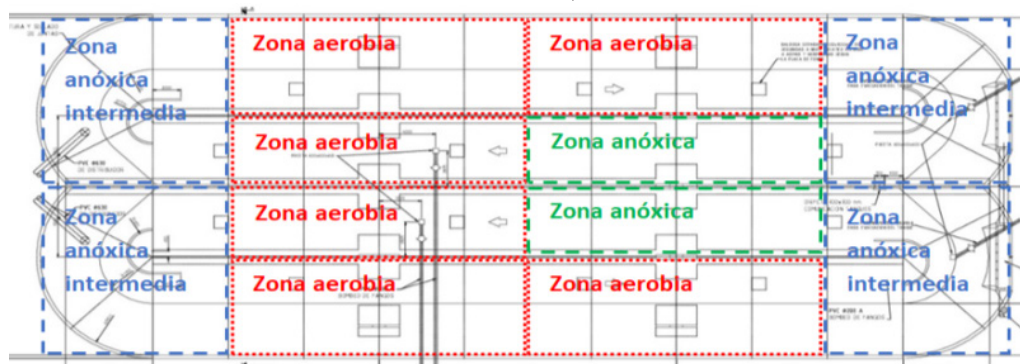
| Distribución teórica en planta de las zonas aerobias y anóxicas en función de los equipos instalados (Fuente: elaboración propia a partir de los planos del Proyecto constructivo de la EDAR).
